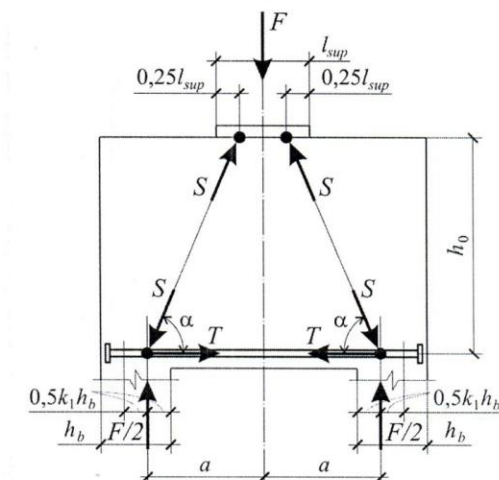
Расчетная аналоговая стержневая модель – АСМ перемычек над проходами колонн
